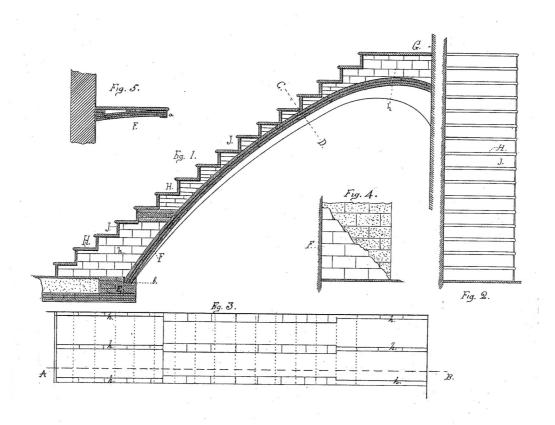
Rafael Guastavino Moreno, 1886. Fire Proof Building, 01. Fuente: US Patent Nº 336047, February, 1886.
